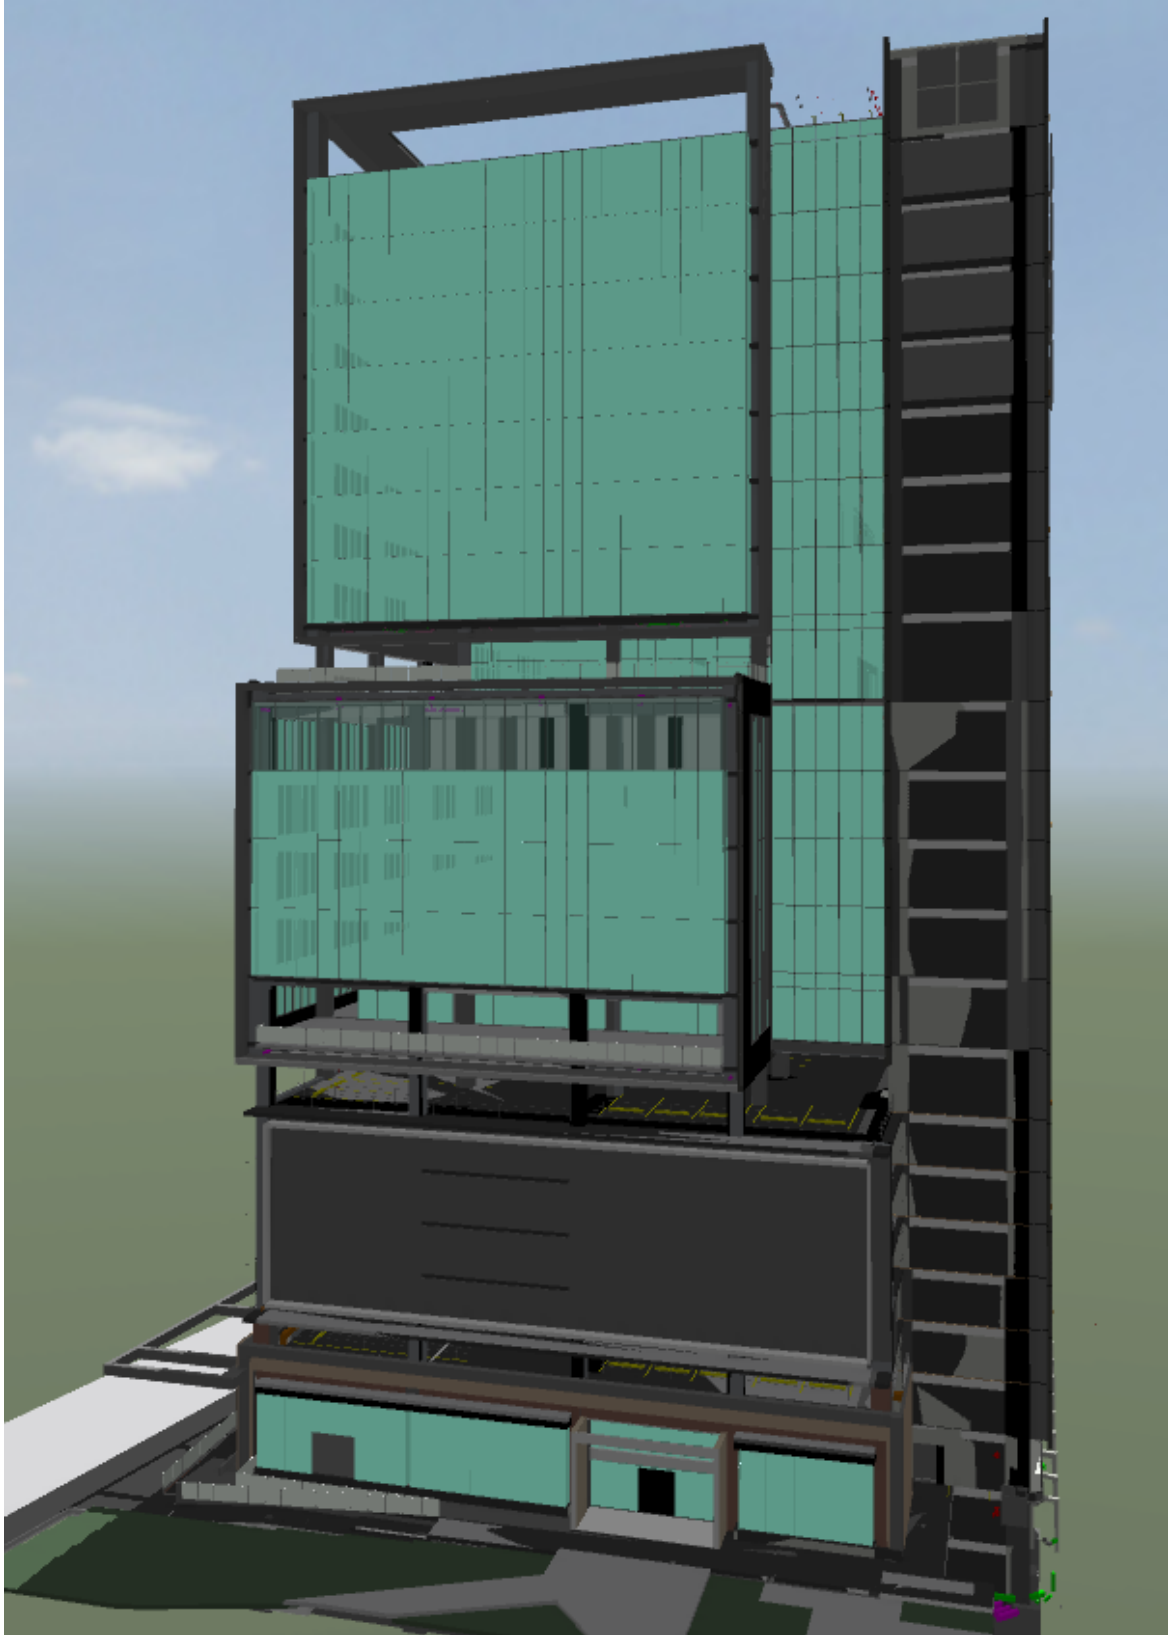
Fachada norte. Fuente: Extralum (2019)
